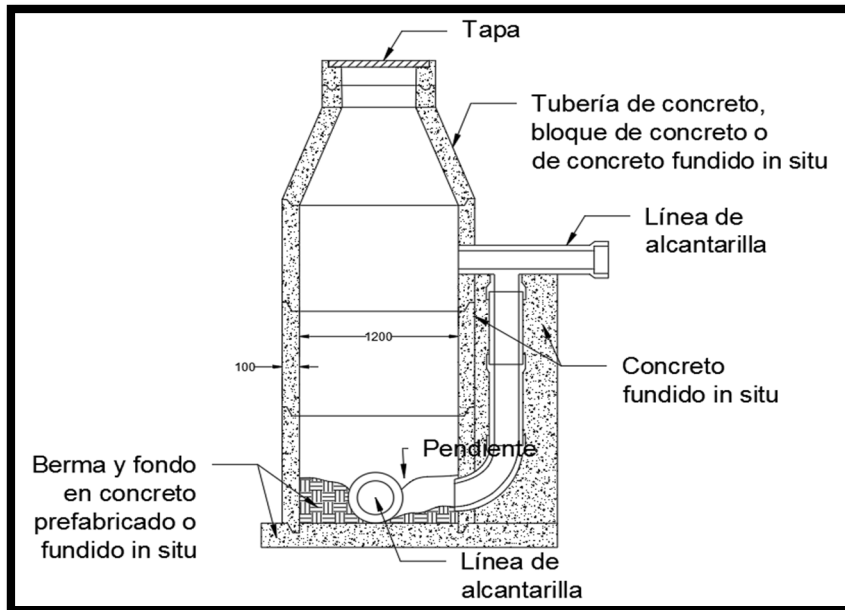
Pozo de inspección en concreto prefabricado con una entrada de caída
